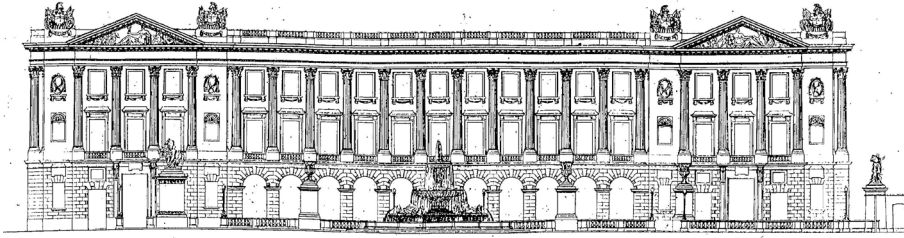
Place de la Concorde, prospetto dell'edificio a est⁴².
